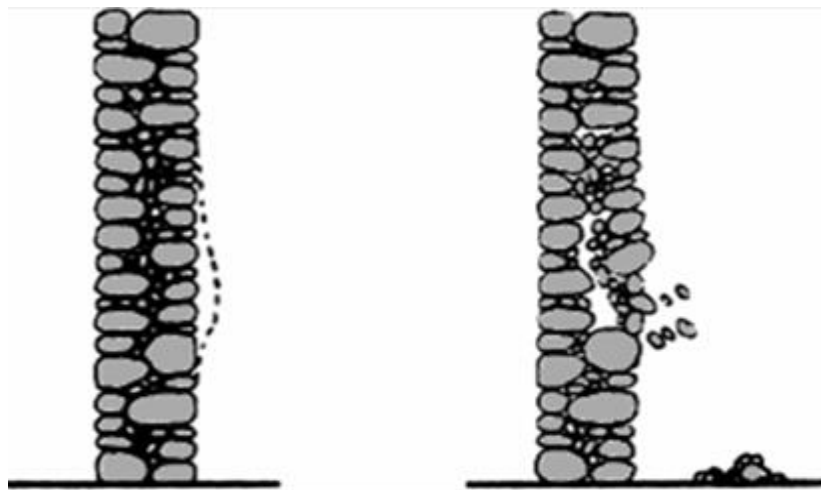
Ilustração de deformação e colapso de um dos panos exteriores de uma parede de alvenaria de pedra, adaptado (BINDA, [et al.], 2000b)
